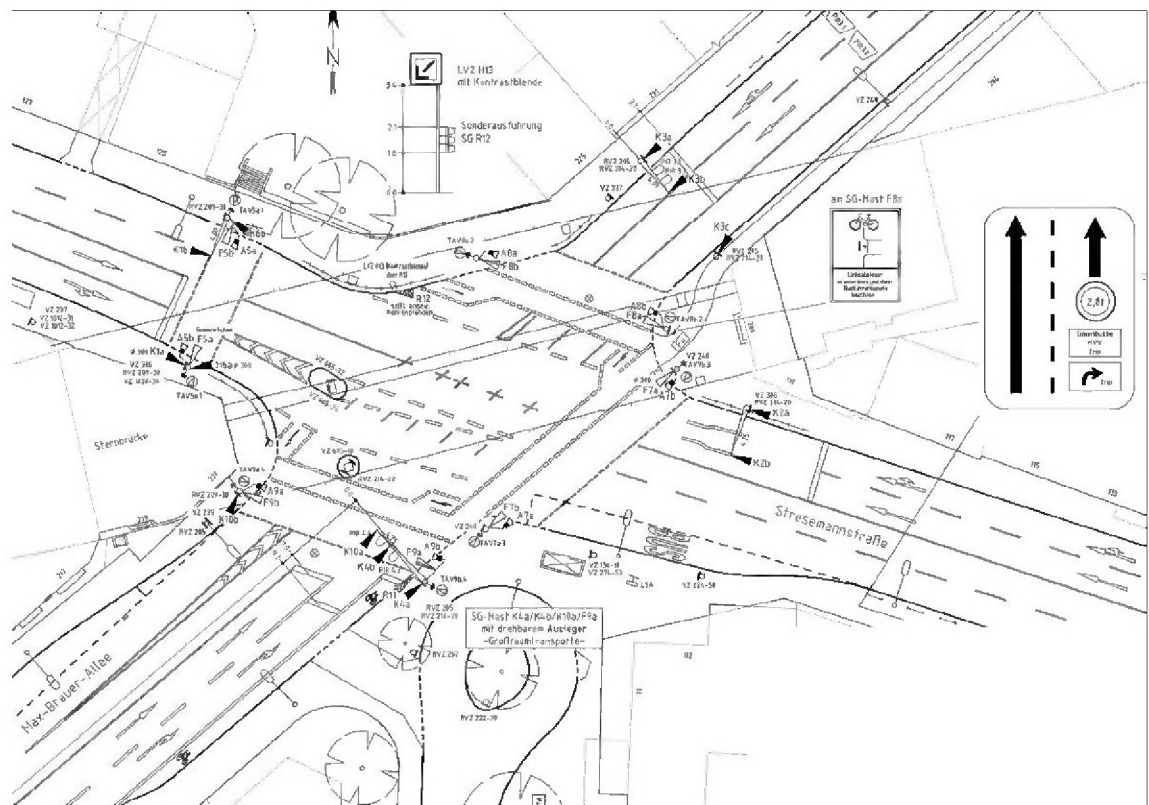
Signallageplan Stresemannstraße/Max-Brauer-Allee – Bestand (05/18-04-06/07)
